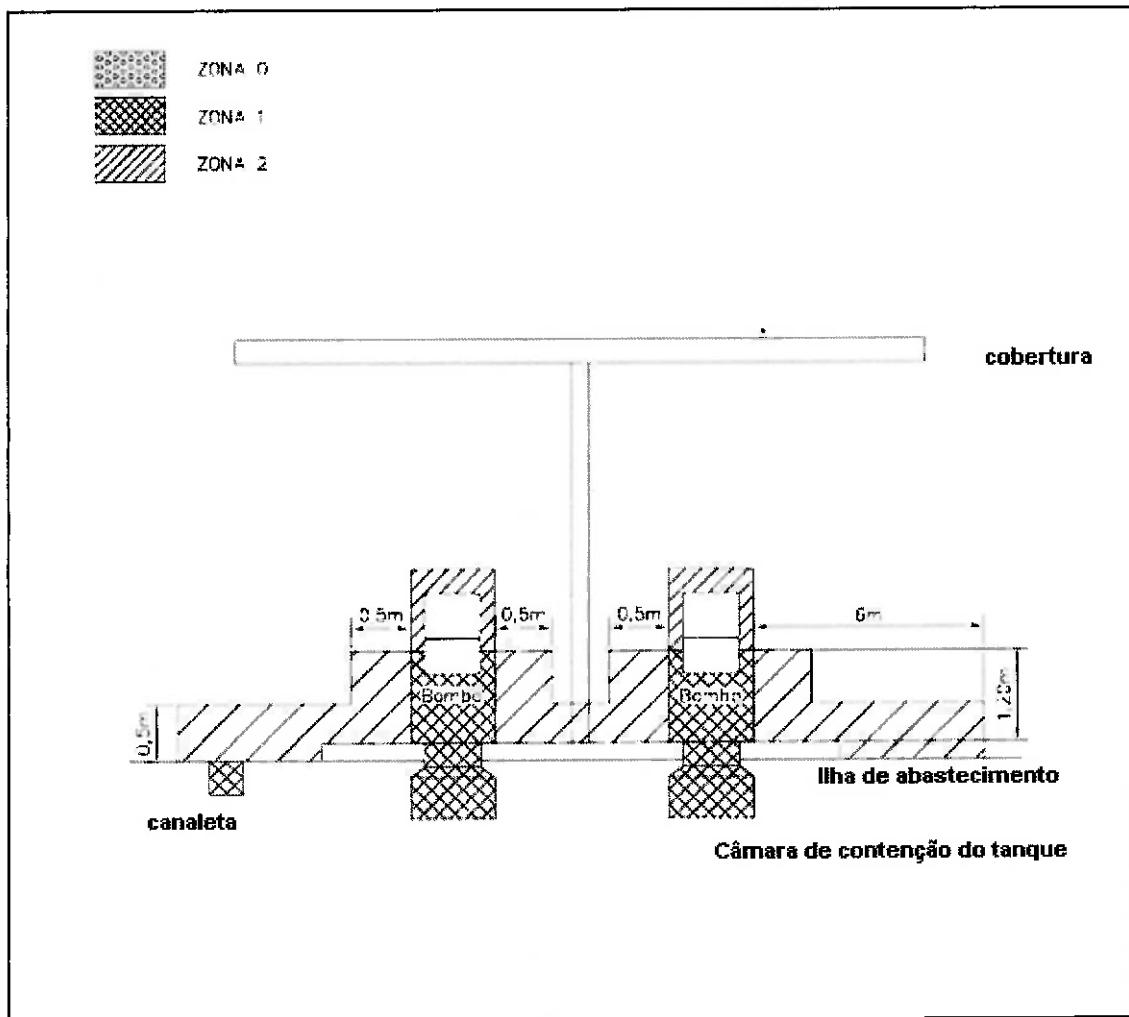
Vista lateral do local de abastecimento - adaptado
